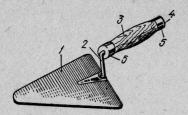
1— полотно; 2— стойка; 3— ручка
